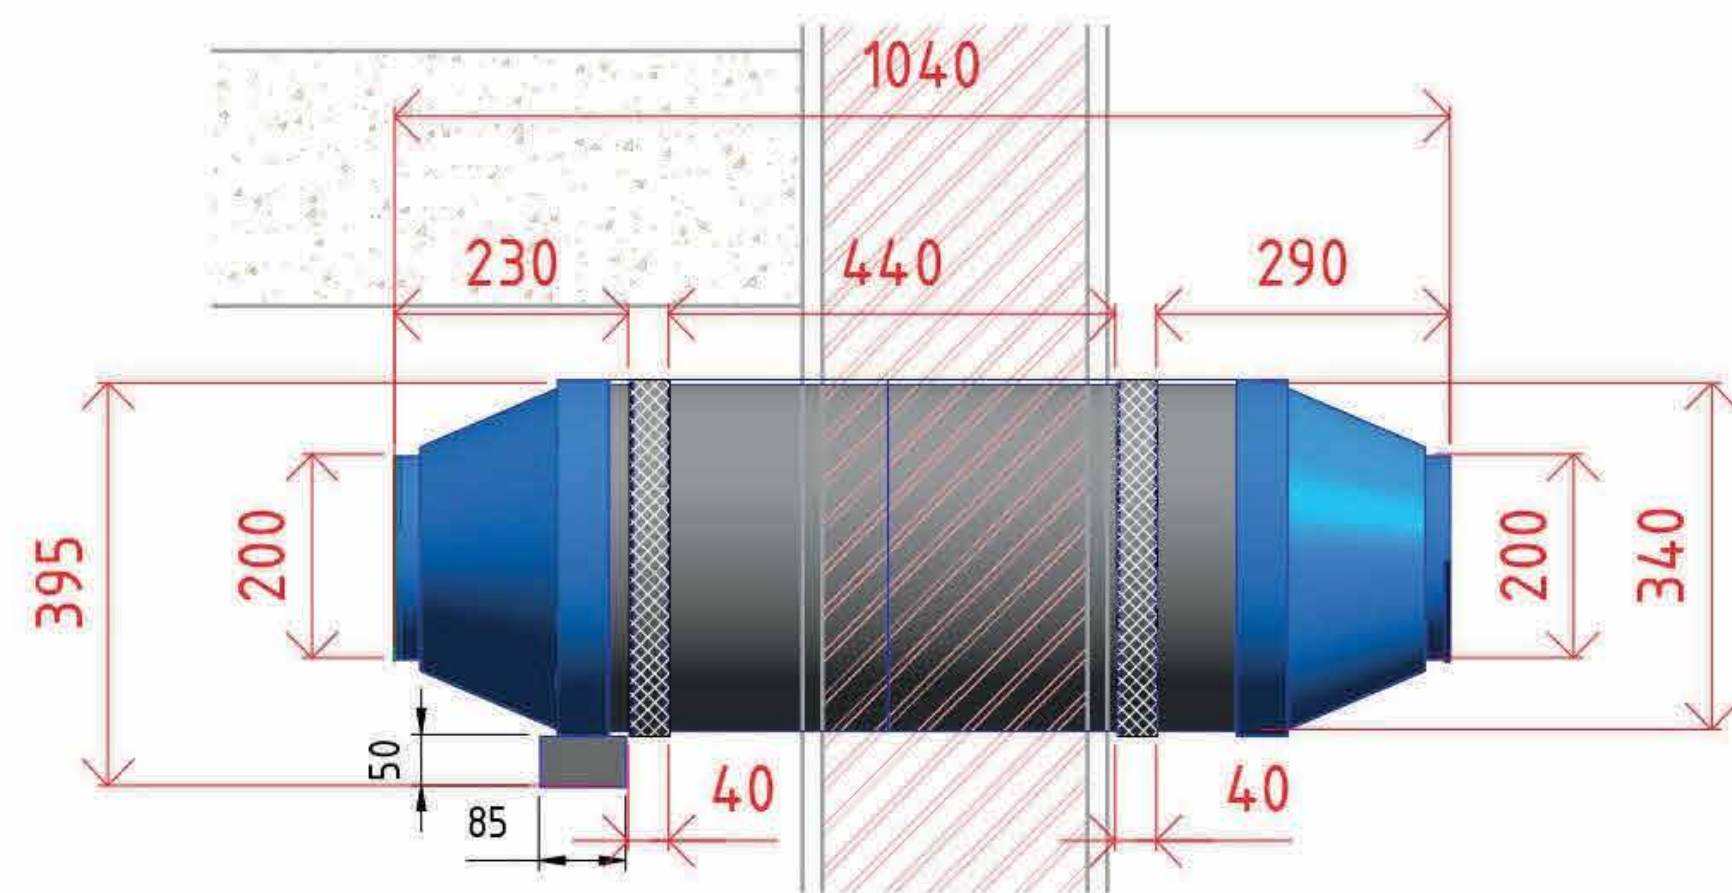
Вид сверху. Стеновая система вентиляции PRANA-340S N°3 расположена в стене
